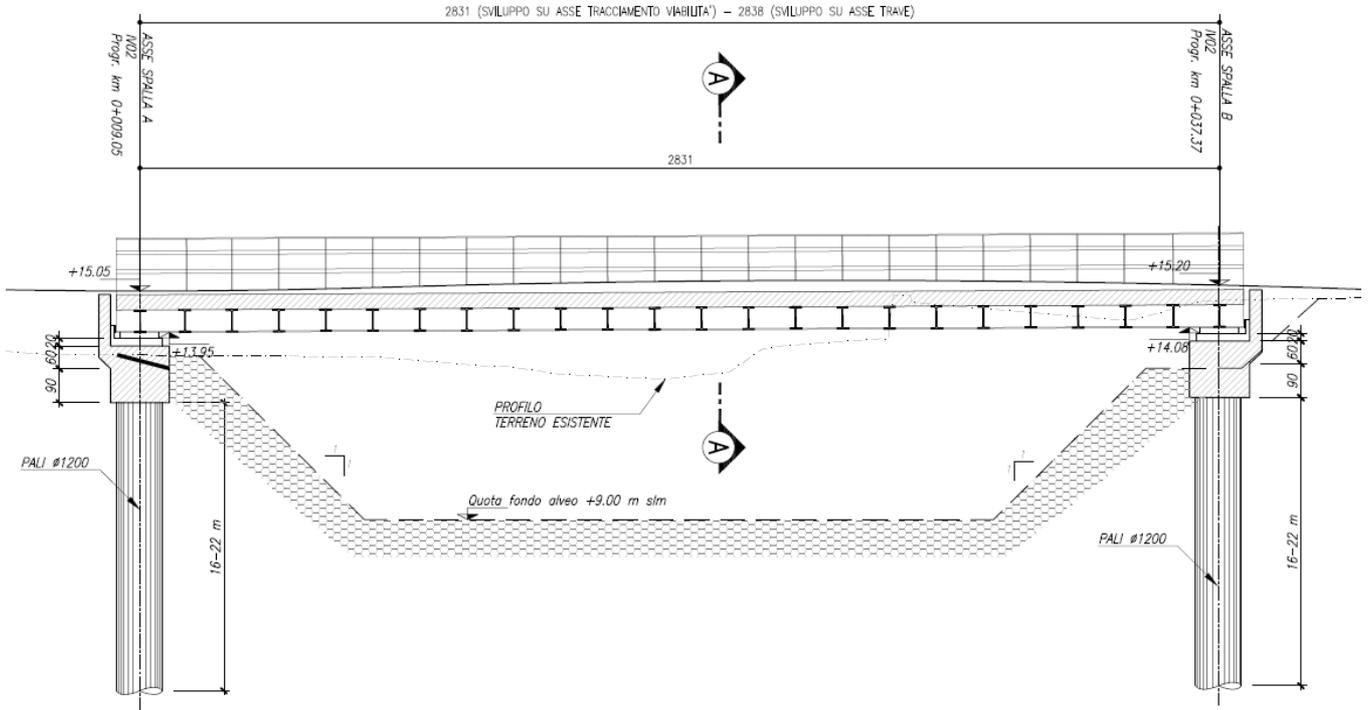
Sezione longitudinale Impalcato (Sezione B-B)
